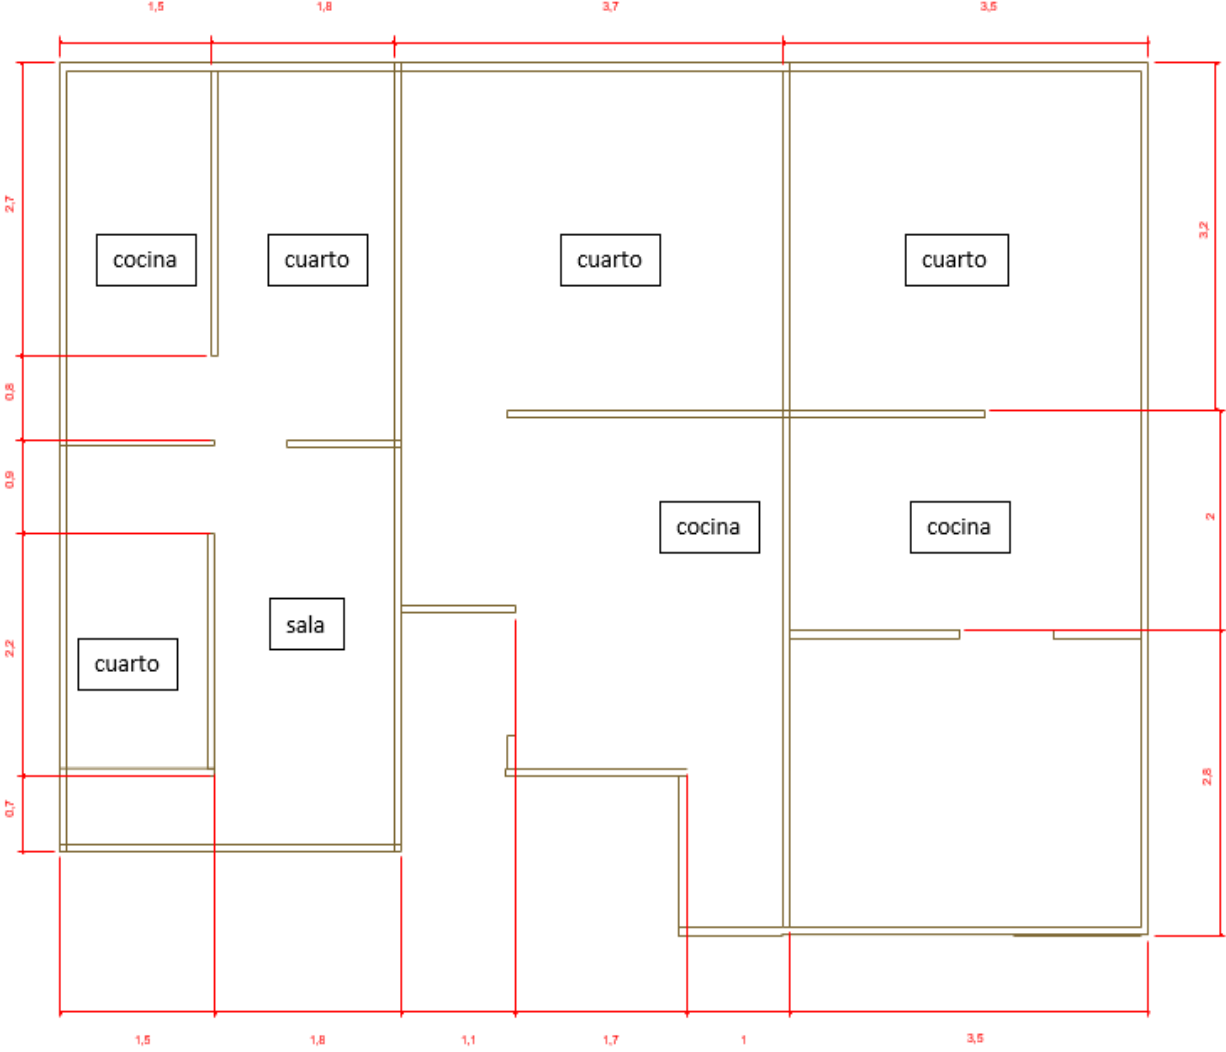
Distribución y divisiones de la vivienda en la segunda planta echa en madera
